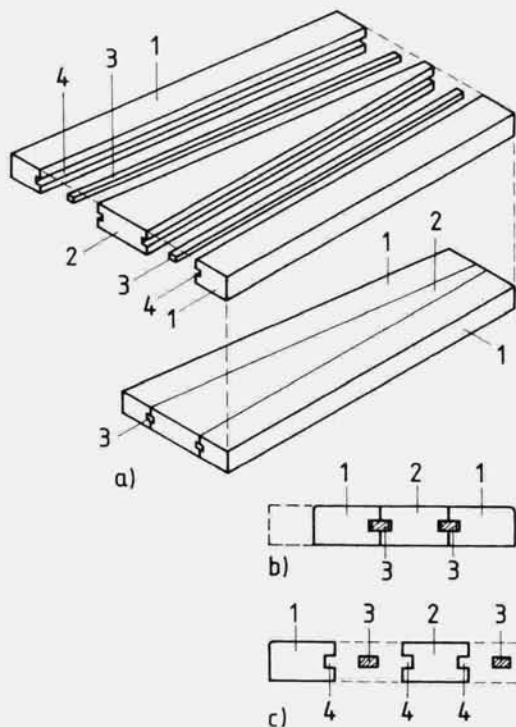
Клиновидная ступень, прикрепленная с помощью распорочной рейки
